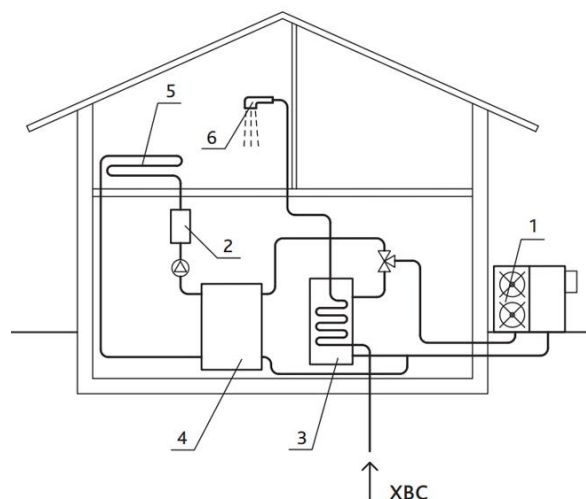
Схема теплоснабжения дома с тепловым насосом: 1 – тепловой насос; 2 – электрический котел; 3 – накопительный бойлер с комбинированным нагревом воды; 4 – буферная емкость; 5 – напольное отопление; 6 – система горячего водоснабжения
